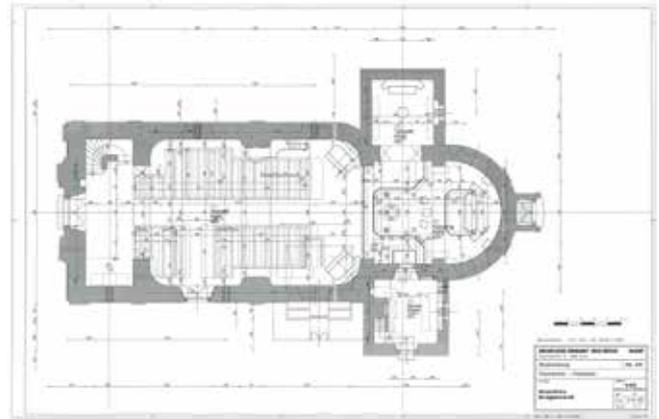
Pfarrkirche Stubenberg, Grundrissplan
